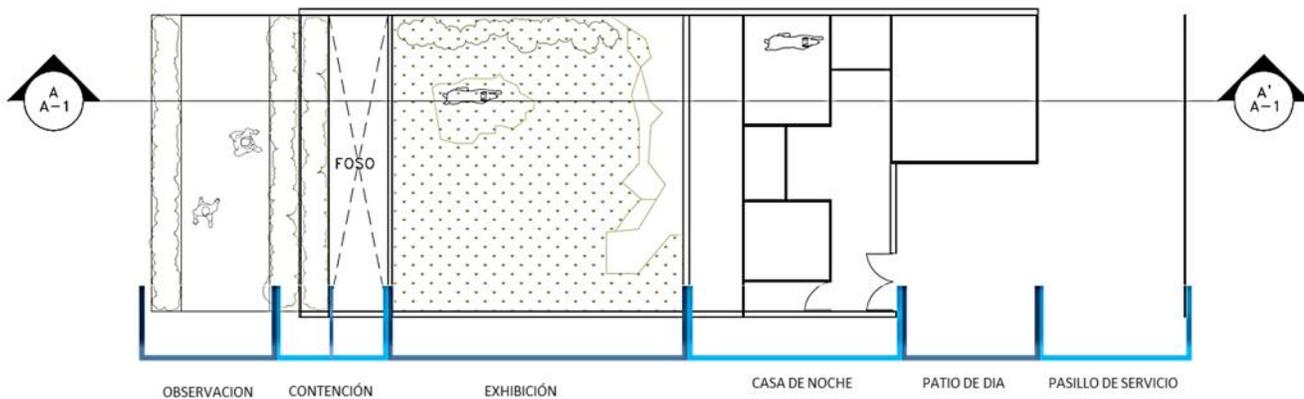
Vista en planta de un exhibidor general; fuente: el autor
